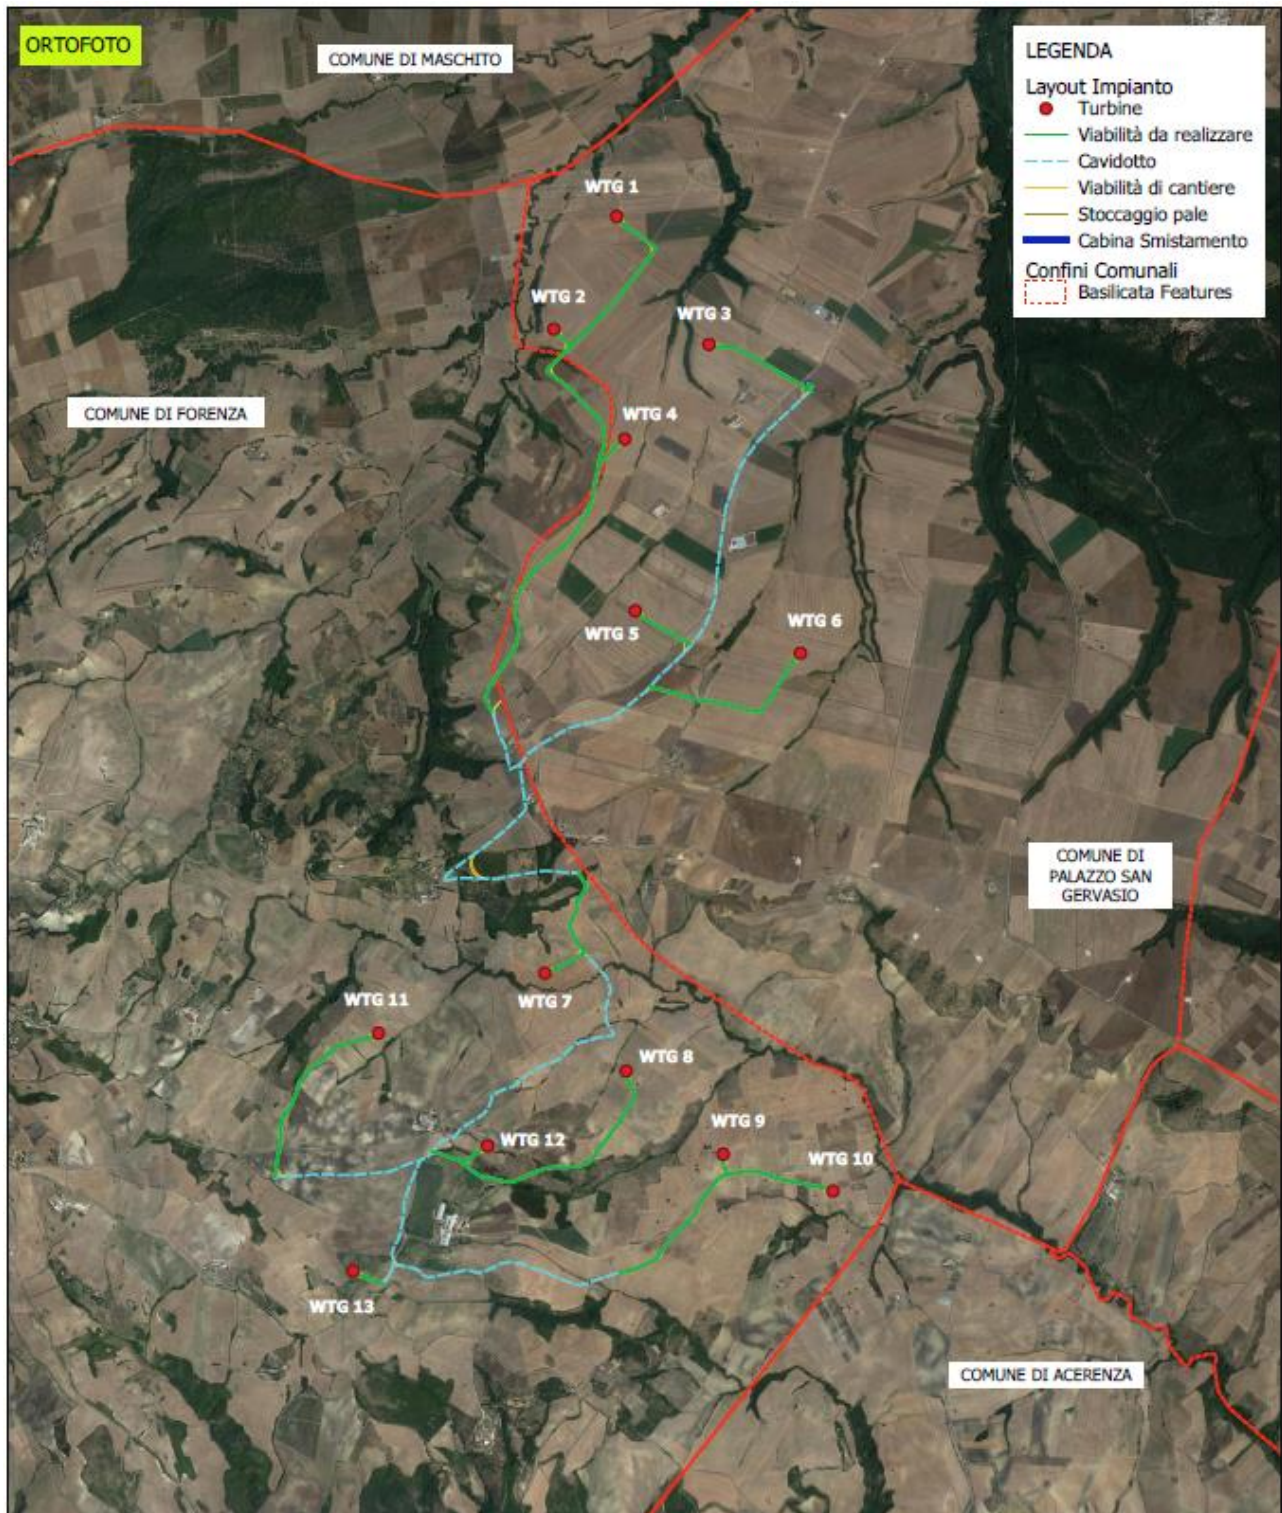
Area di intervento: dettaglio layout di progetto su ortofoto
